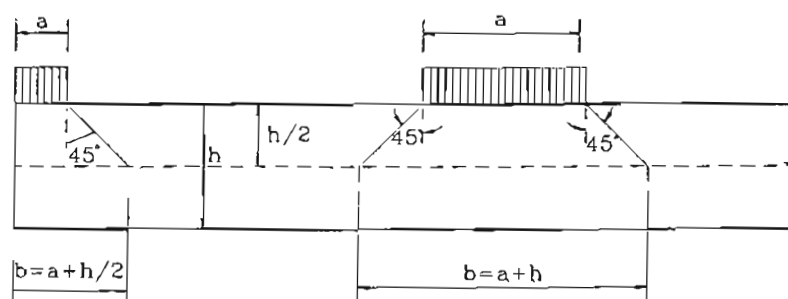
Distribuição de ações no plano médio da laje
